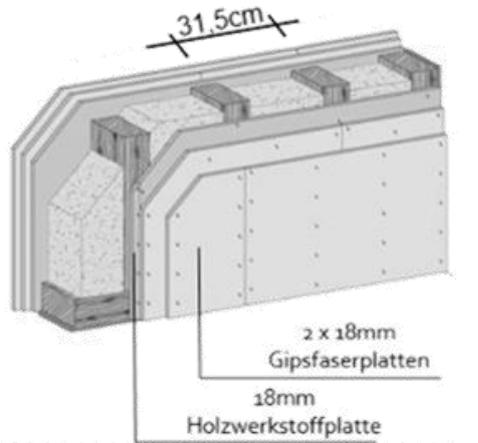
Wandaufbau für mechanisch-beanspruchte Wand mit Holzwerkstoffplatte 18mm [Fermacell]
